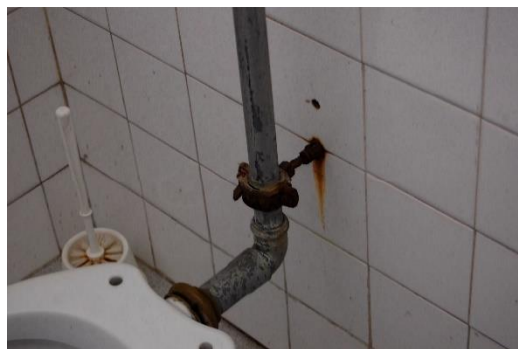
Corrosão dos elementos metálicos de fixação da tubagem [Fonte: Autora]
